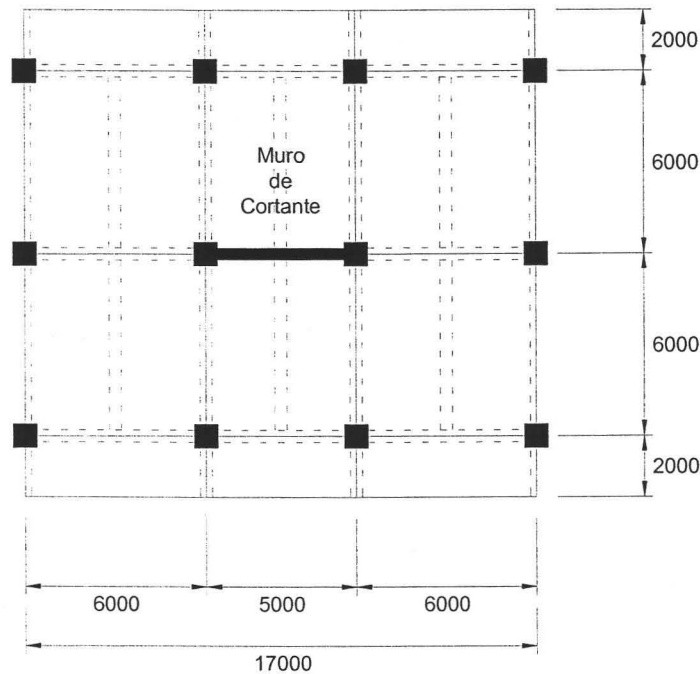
Vista en planta del modelo de 7NEC (acotaciones en mm)
